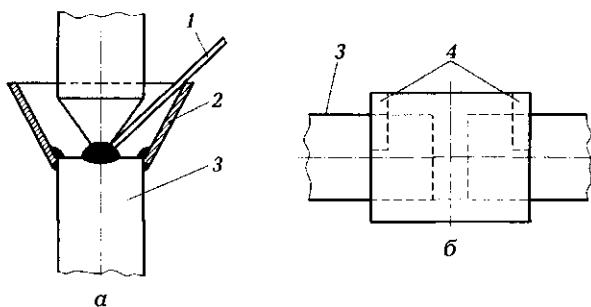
Схема сварки ванным способом вертикальных (а) и горизонтальных (б) стержней железобетонной арматуры:
